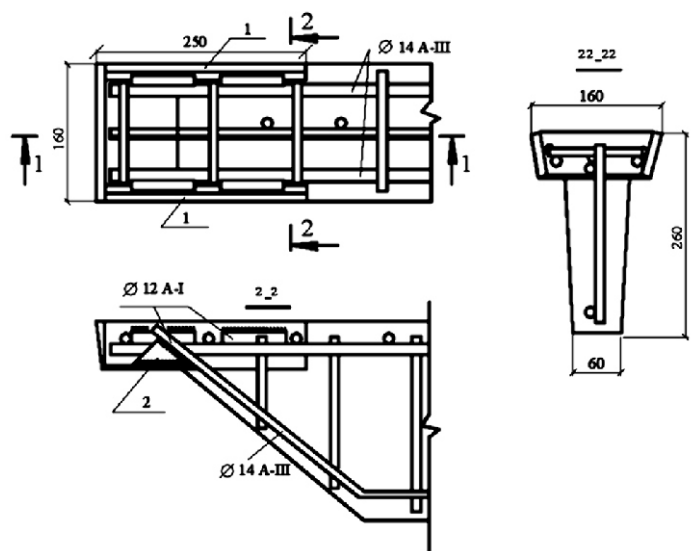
Арматура опорного вузла прогону ПЖТ 6-500:
